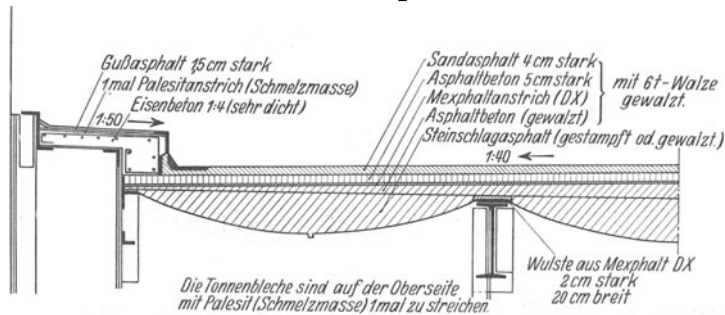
Fahrbahnbefestigung der Rosensteinbrücke in Cannstatt mit Ausfüllung der Buckelplatten mit Asphaltmassen.
